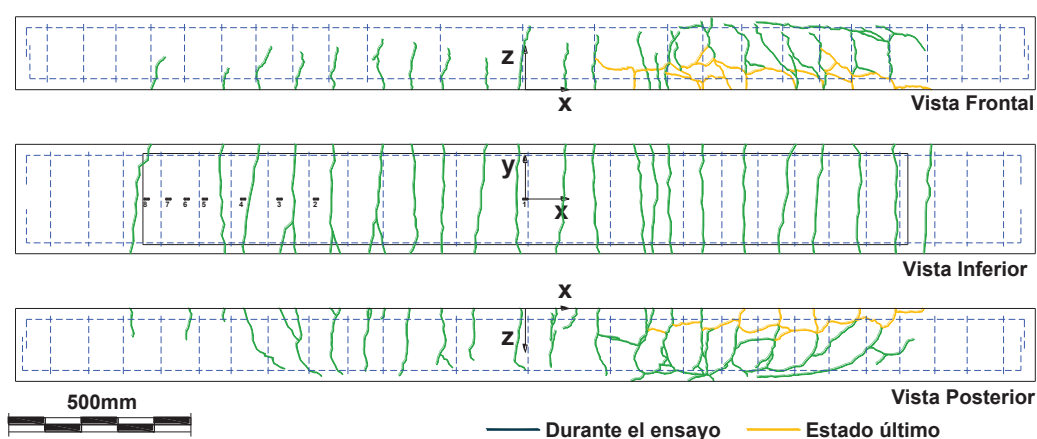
Esquema del patrón de agrietamiento de la viga 3B durante el ensayo por carga última.
